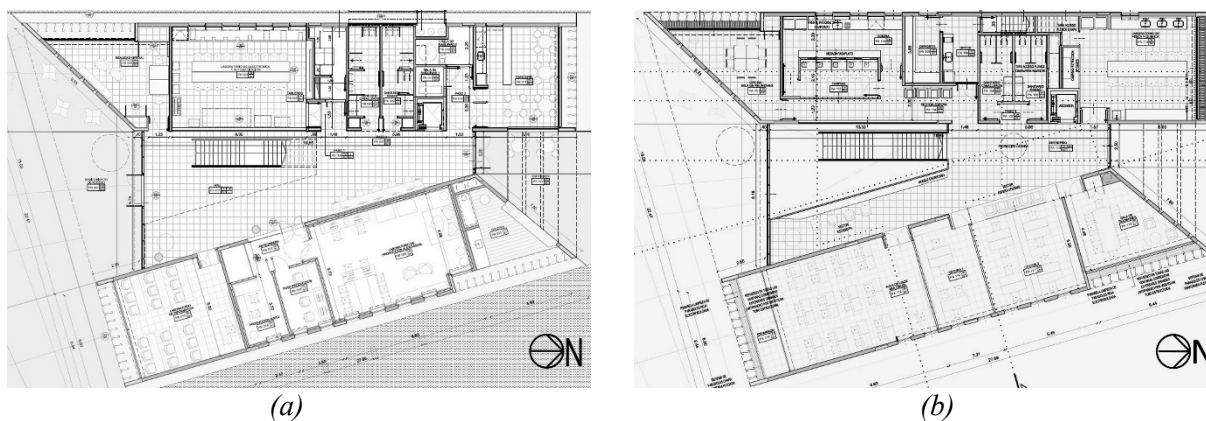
Edificio 1 Campus UNRaf, (a) vista planta baja, (b) vista planta alta.
